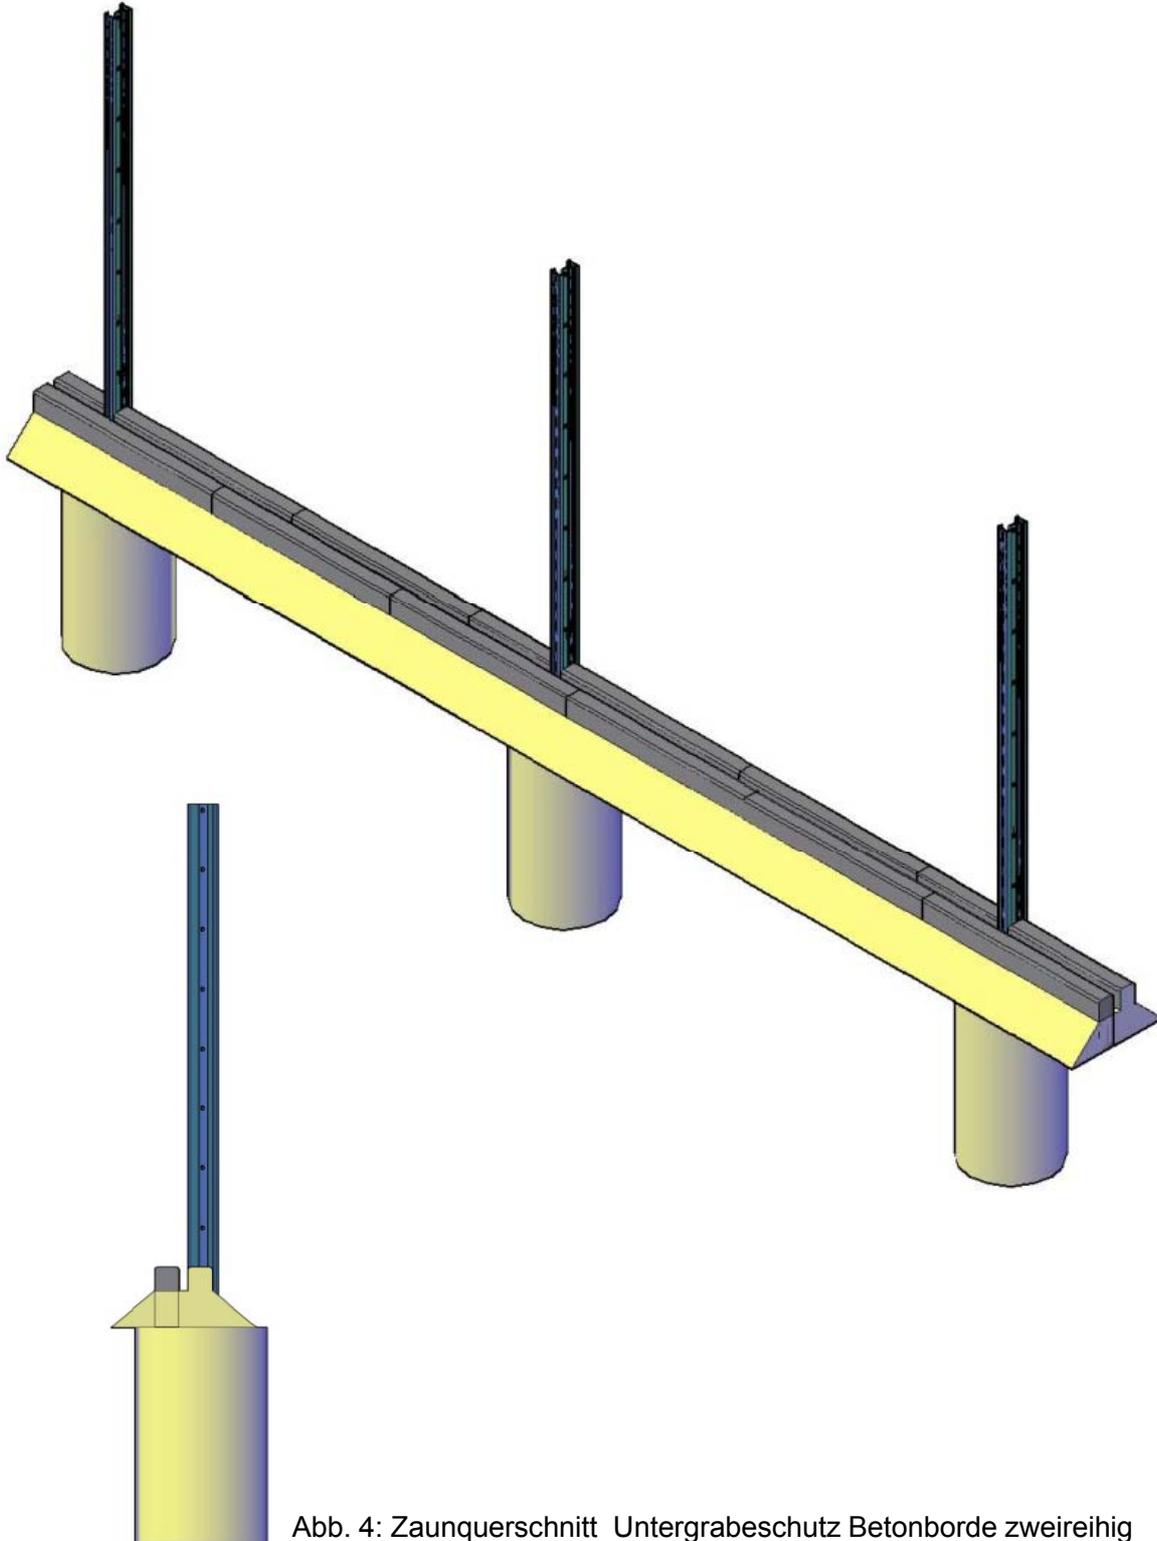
Zaunquerschnitt Untergrabeschutz Betonborde zweireihig
